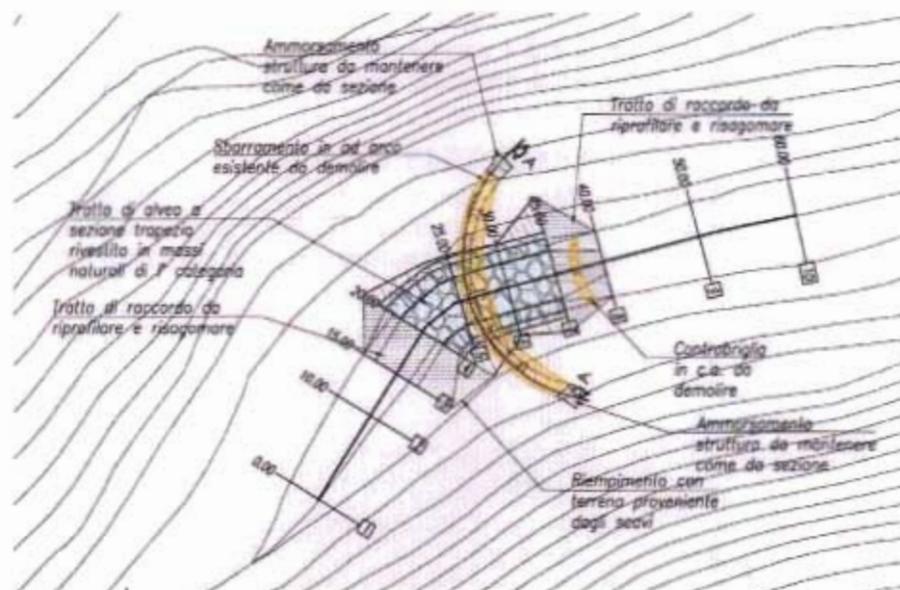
Planimetria sistemazione idraulica sbarramento SA01
